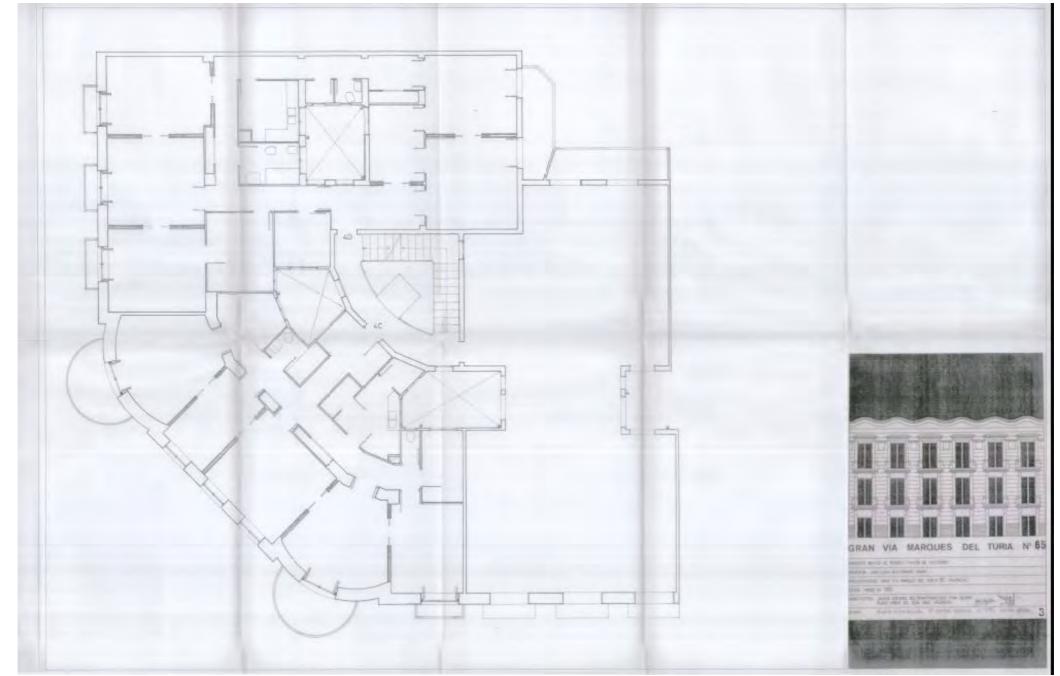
Planta cuarta estado actual proyecto de rehabilitación 1985
